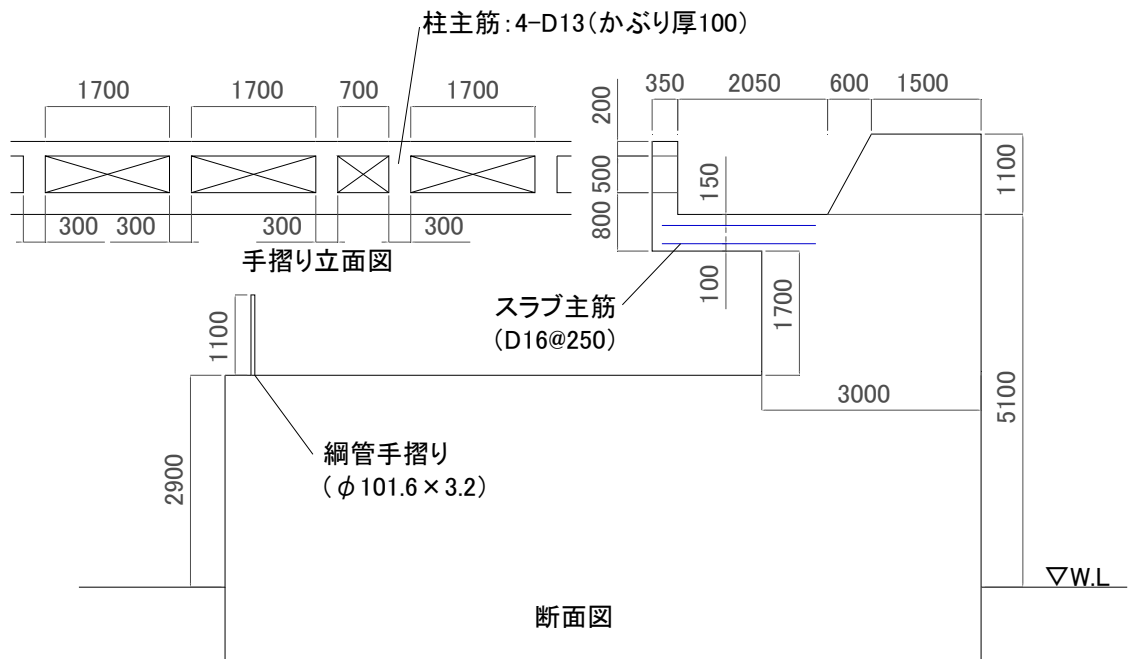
堤防の断面図・立面図（単位：mm）（航空写真点線丸印部分）
